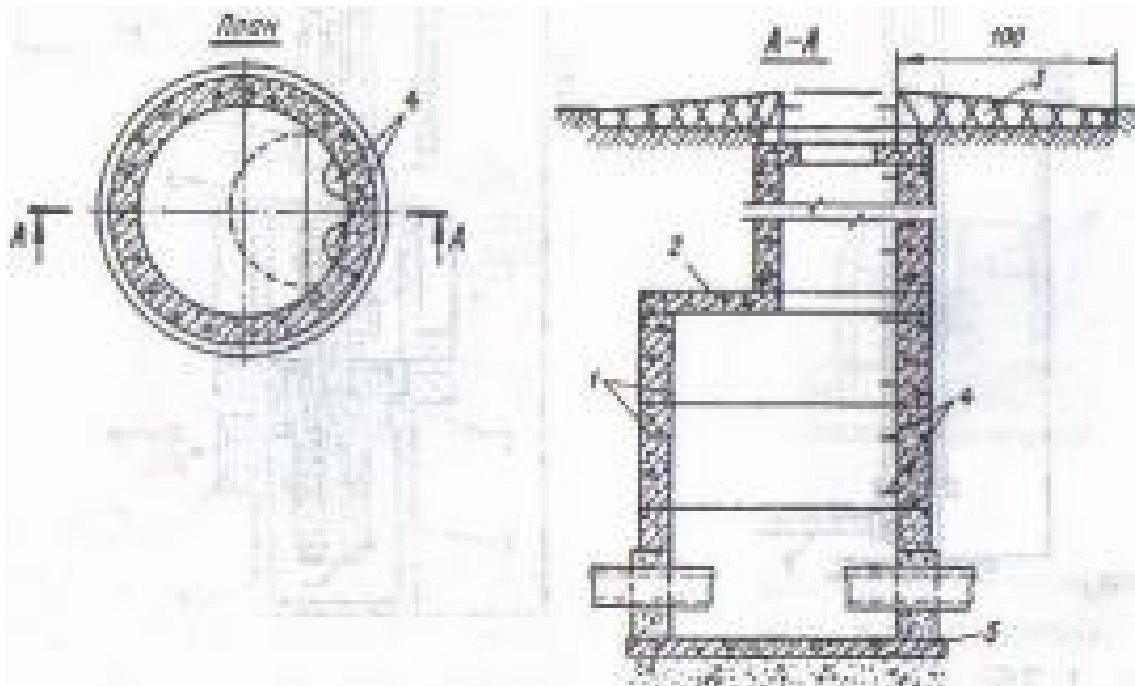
14. Збірний залізобетонний оглядовий колодязь: 1 — кільця; 2 — плита перекриття; 3 — вимощення; 4 — ходові скоби; 5 — плита дна
